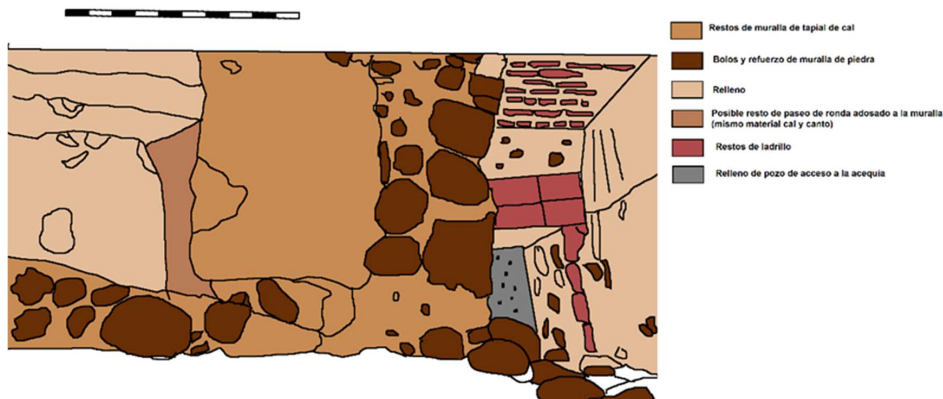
Zona del dormitorio de la 1ª planta con cambio de dirección de la muralla y acceso a la acequia desde el pozo.
